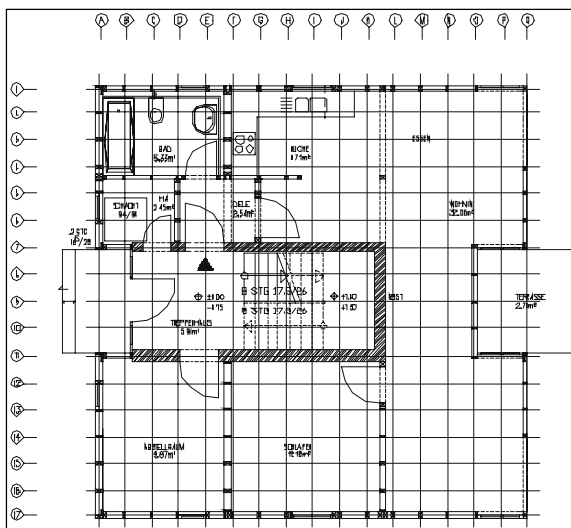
Wohnungstyp 3 Grundriss EG
